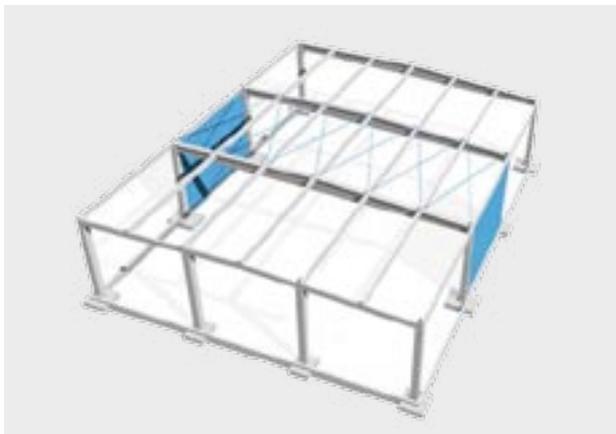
Aussteifung durch Dachverbände und Wandscheiben
